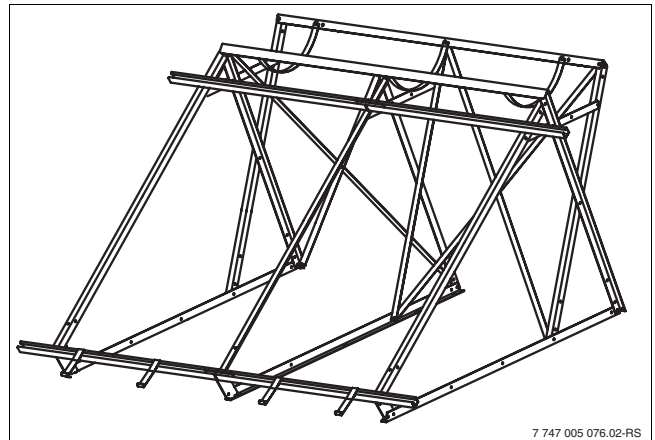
Vista de conjunto del soporte para cubierta plana (sistema de 300 l)
